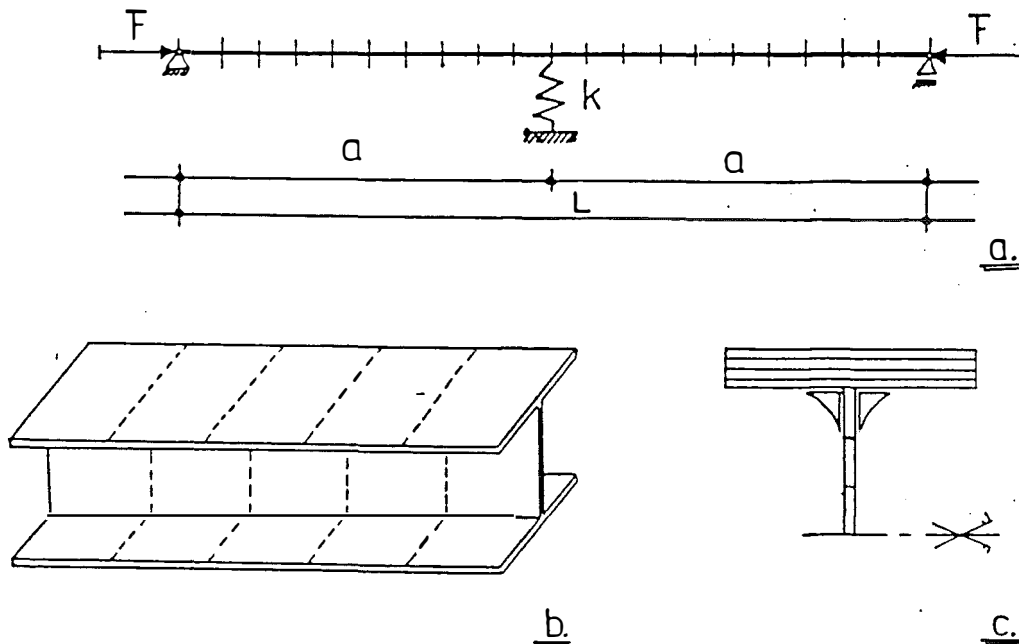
a: Verdeling van de elementen over de kolom.
